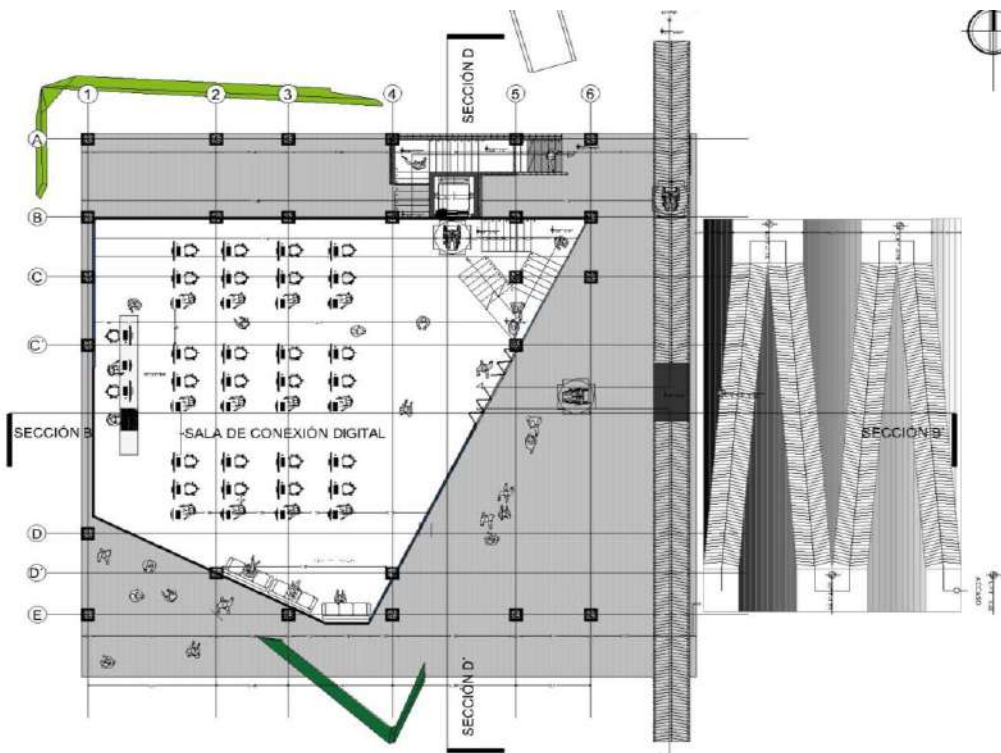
Planimetría detallada edificio lúdico nivel +/- 0.00. Fuente: Elaboración propia 2021.
